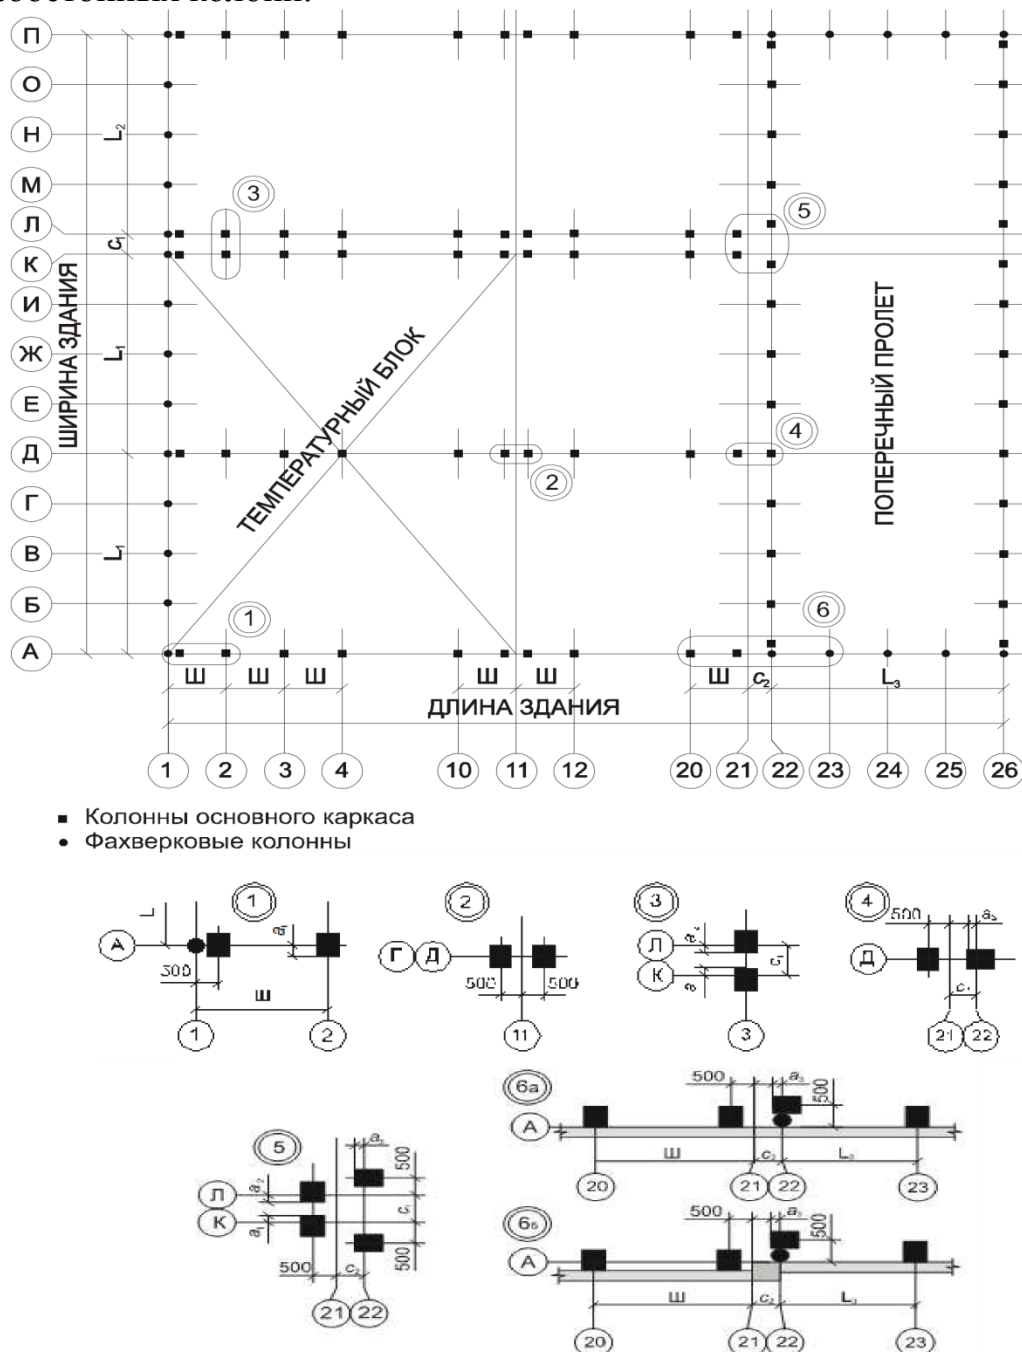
Схематический план (сетка разбивочных осей) одноэтажного промышленного здания с тремя продольными и одним поперечным пролетами
